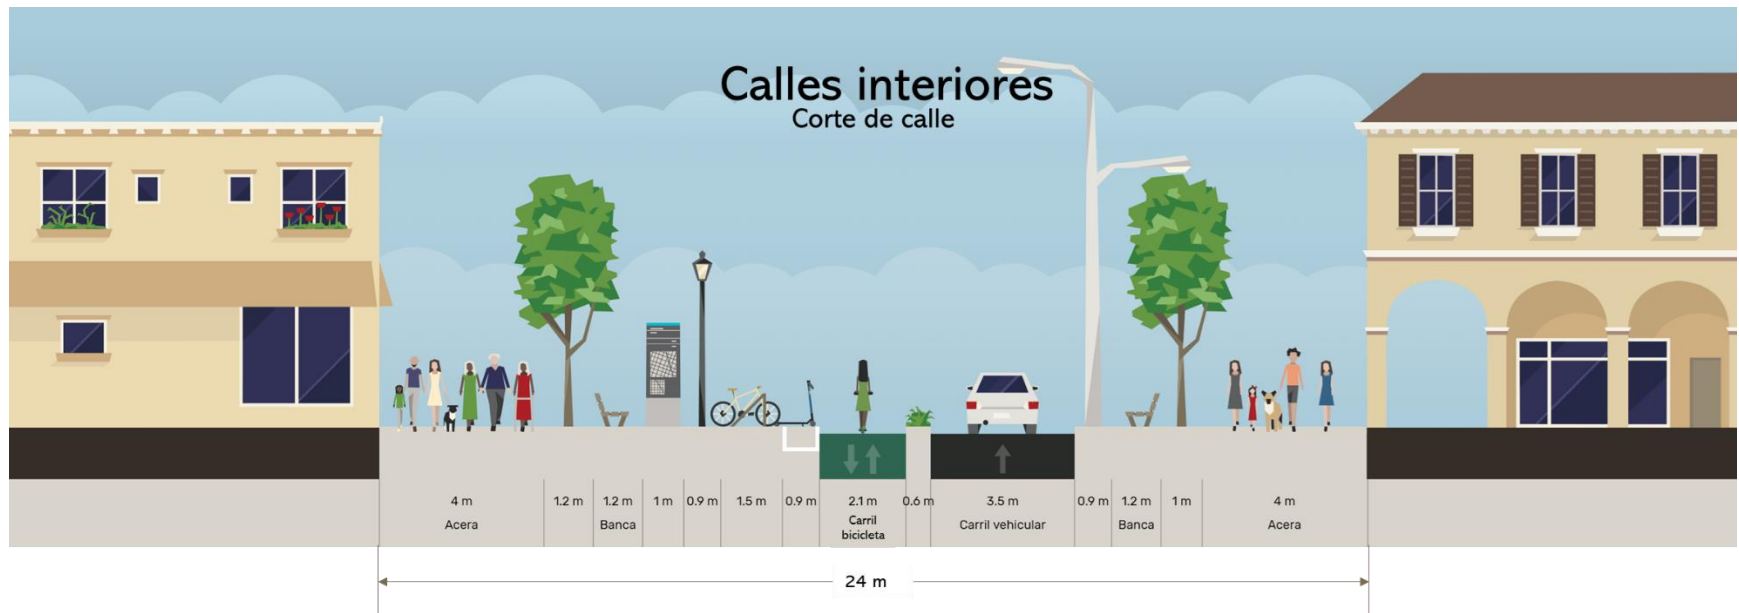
Detalle distribución de propuesta para calles interiores (corte).
